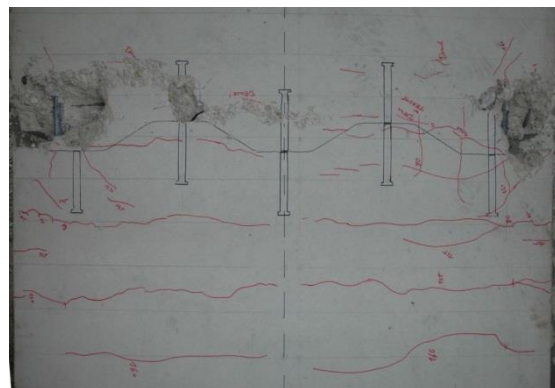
Betonausbruch auf der lastzugewandten Seite des Betongurts an Körper R-Q3
